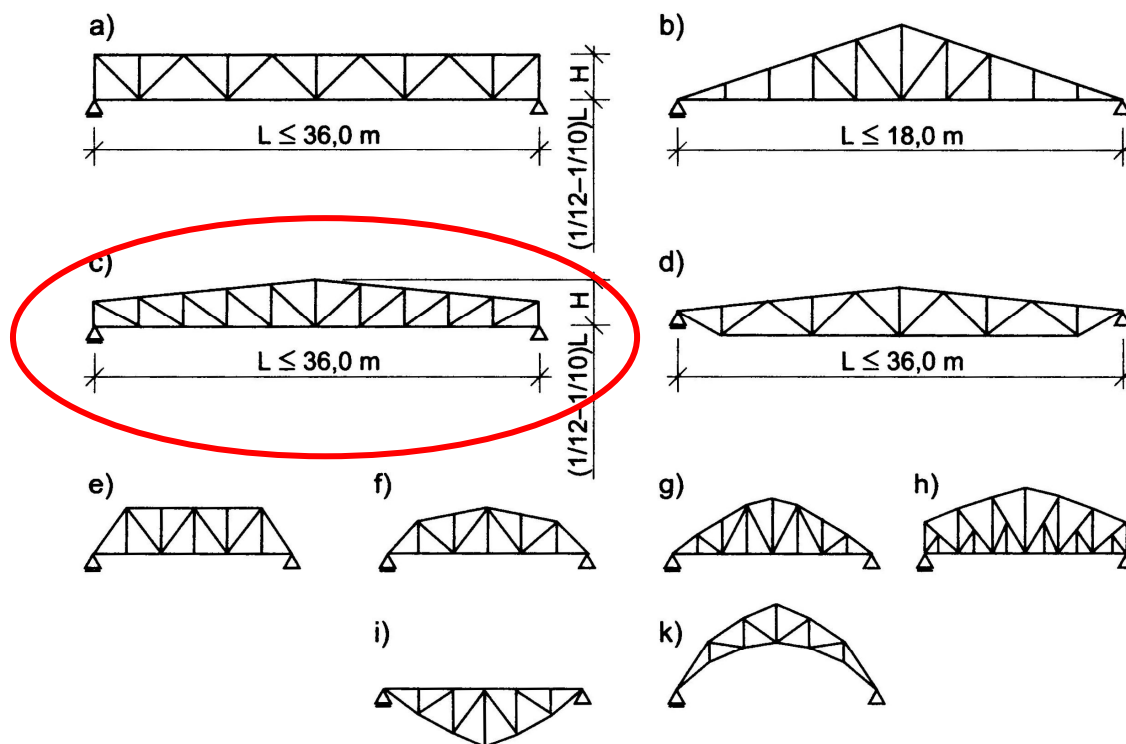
Konstrukcja dachu bezpłatwiowego
